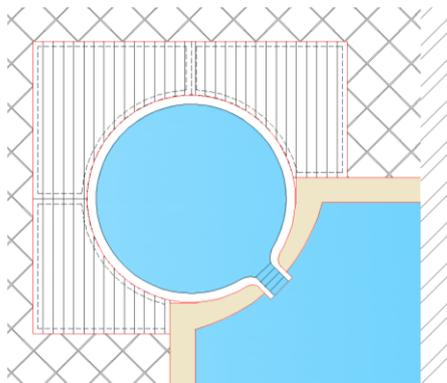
Installazione ad angolo – cavedio rettangolare
